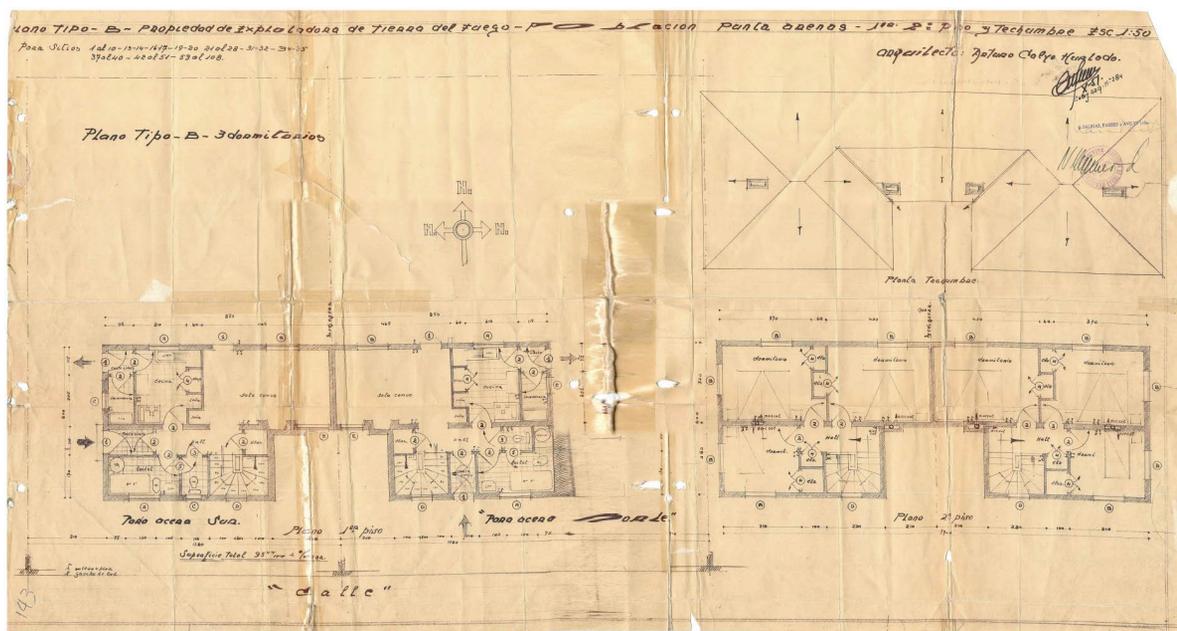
Plano de planta de arquitectura modelo Tipo B (Expediente N° 200 Población Explotadora, 1952).
